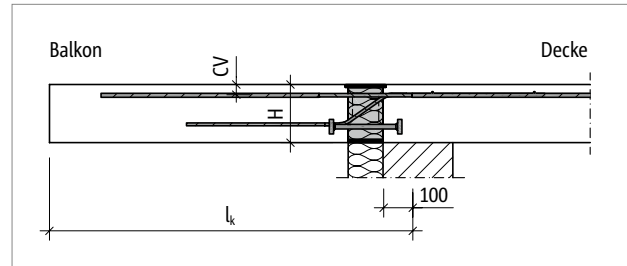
Schöck Isokorb® XT Typ KP-M11: Statisches System
